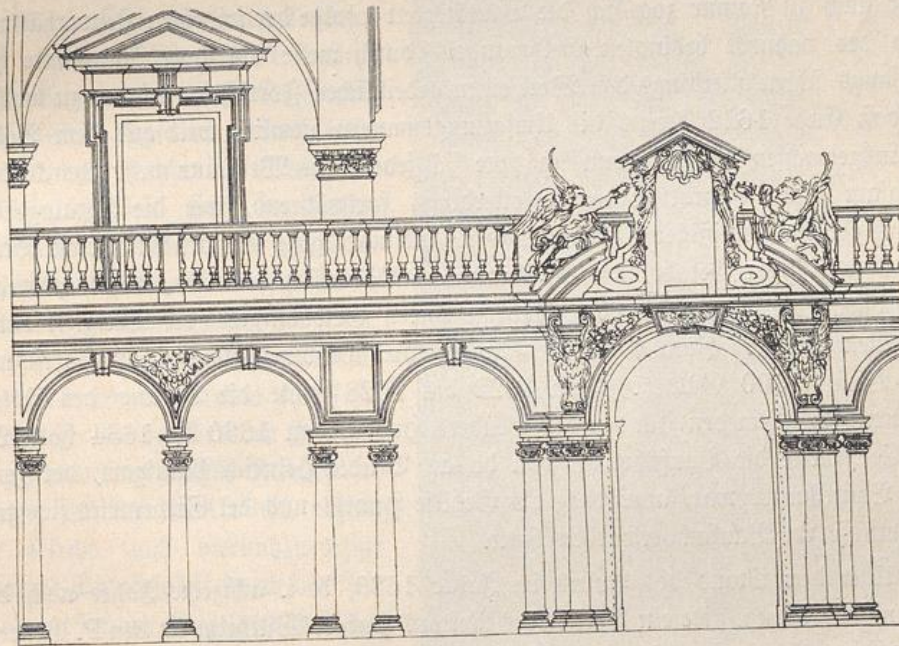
Brügge. Frühere Jesuitenkirche. Bruder Huyssens Plan zur Empore.
